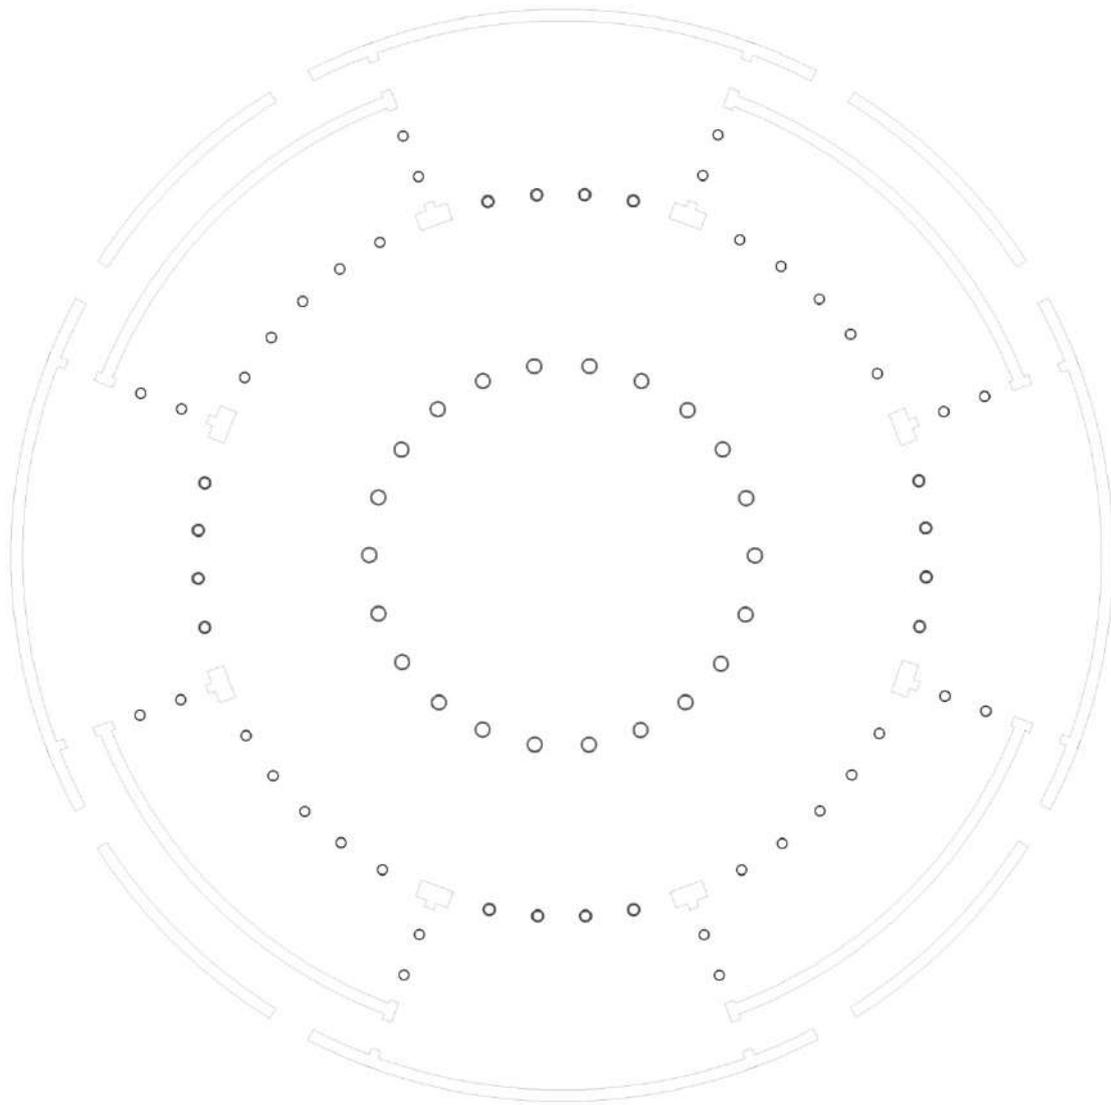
Santo Stefano Rotondo, Raumplan des ursprünglichen Baus
